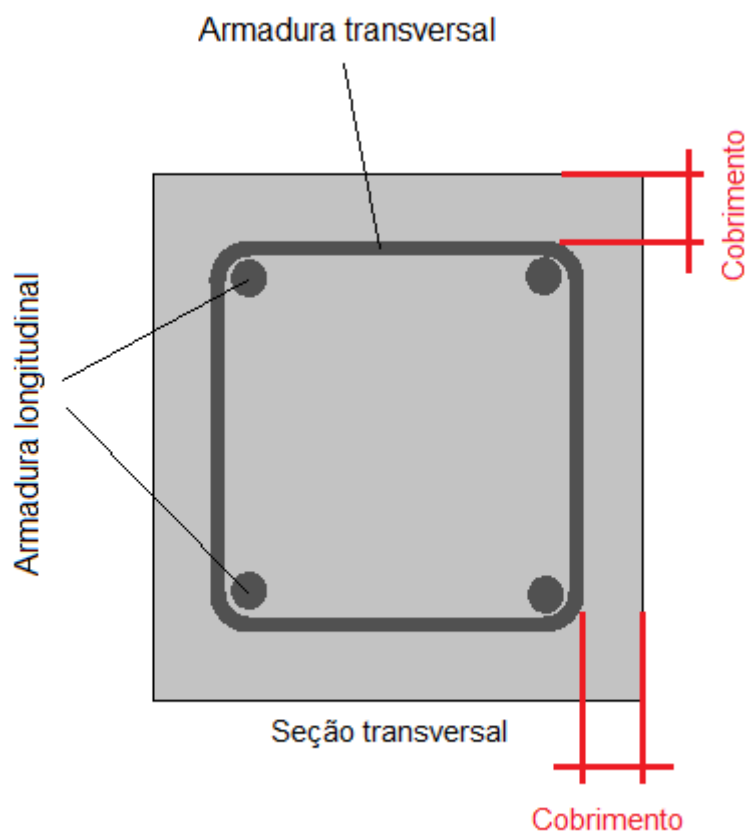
Cobrimento de armaduras em elementos de concreto armado.
